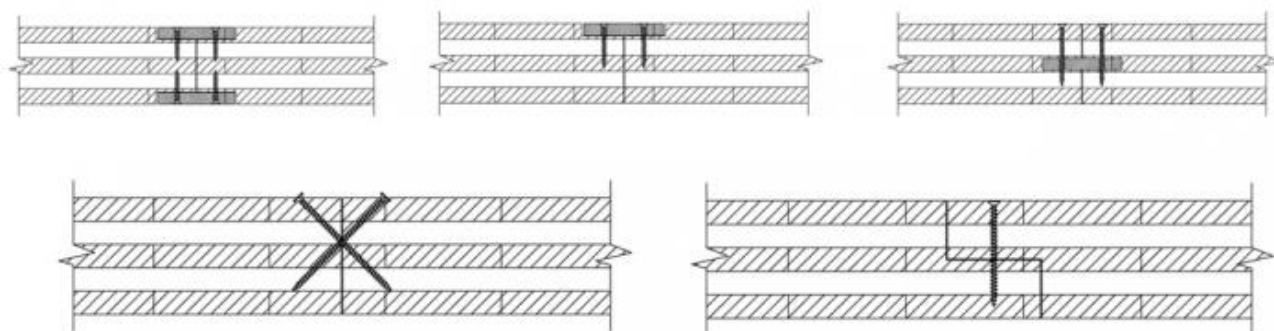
Collegamento pannelli orizzontali [7]
